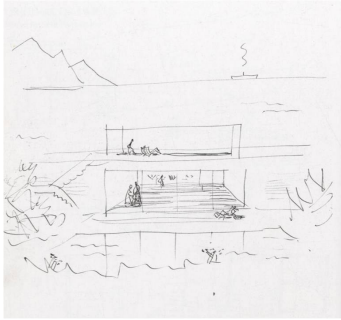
Boceto vista planta baja y solárium (Alejandro de la Sota, 1984)
